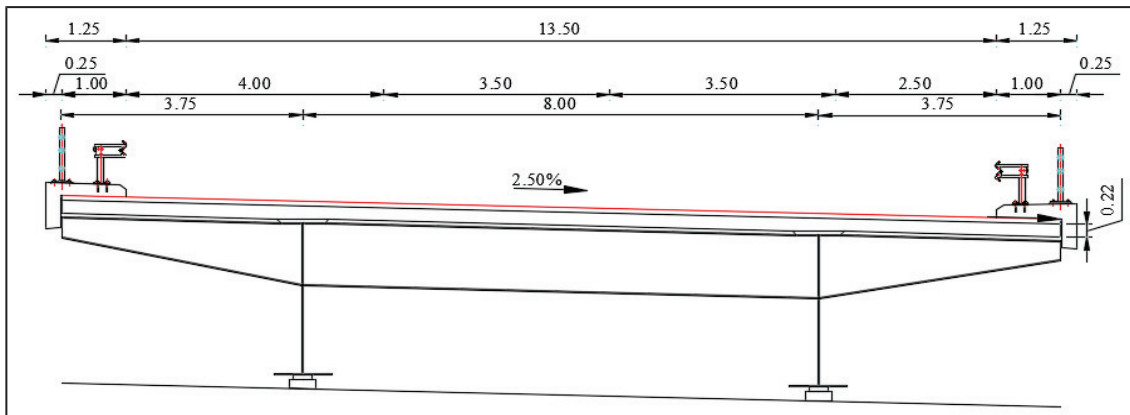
La coupe transversale de la variante pont mixte acier-béton.
